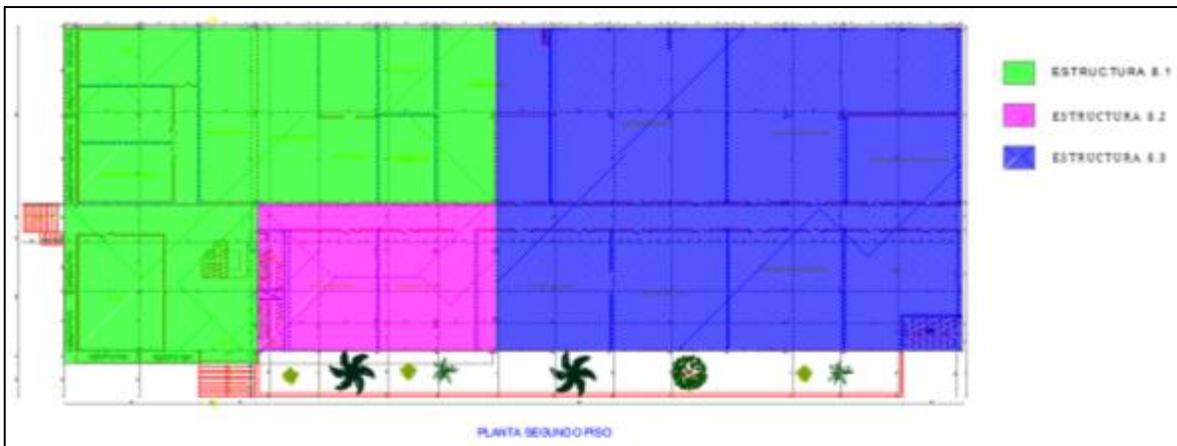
Estructura 8. Ubicación de estructuras 8.1, 8.2 y 8.3
